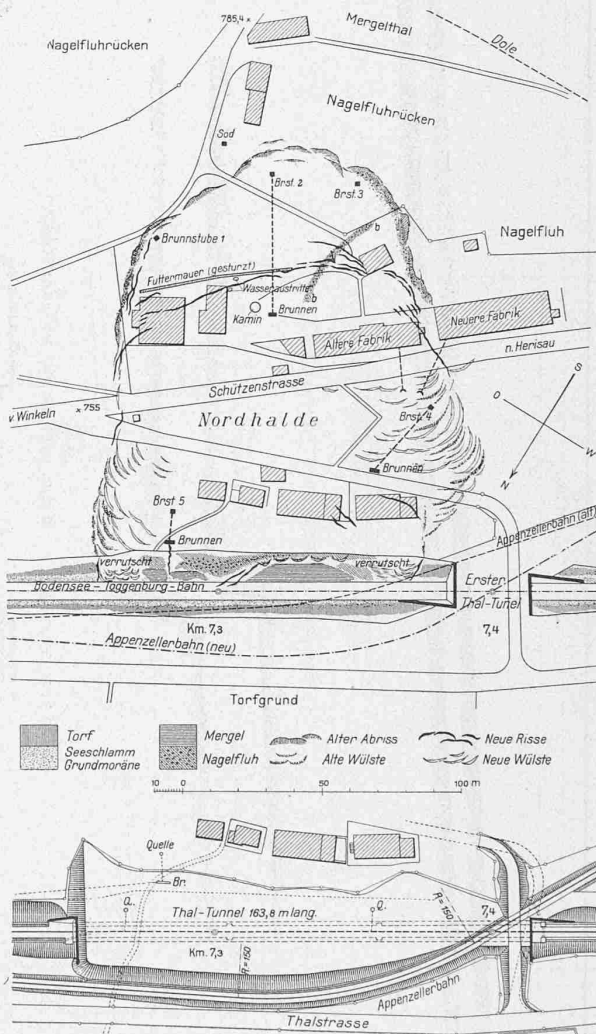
Rutschungen an der Nordhalde bei Herisau. Lageplan 1 : 2500.
